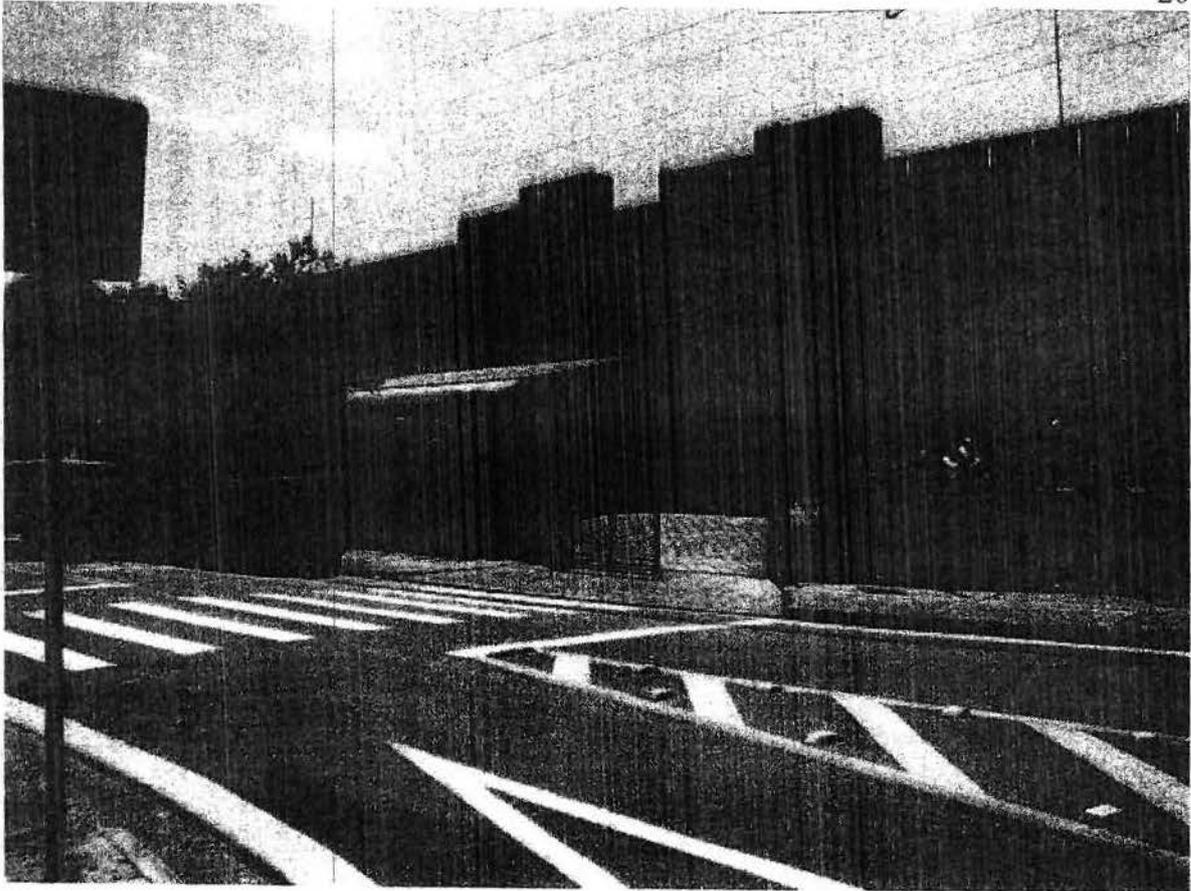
Vista da fachada do Prédio da DEPHAS.
